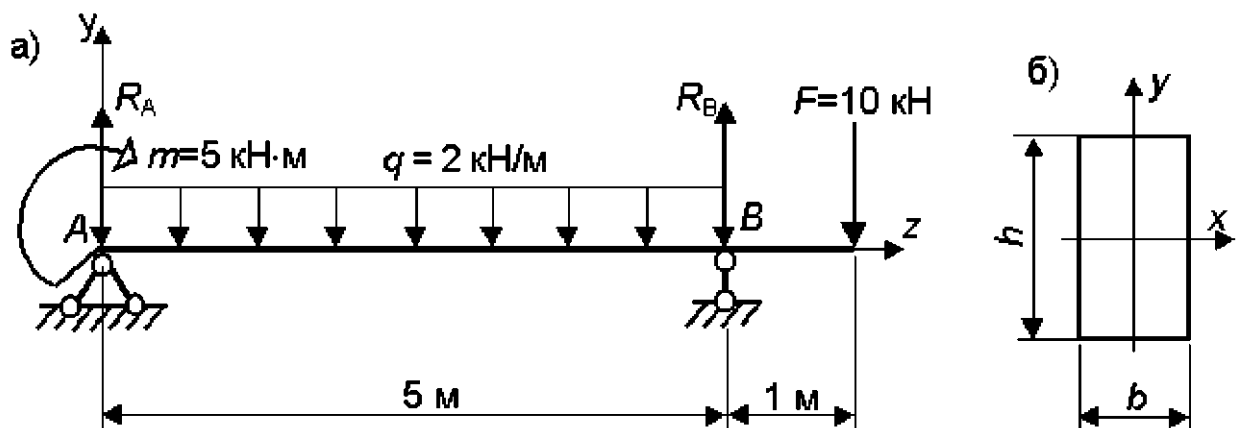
Схема балки: а) расчётная схема; б) схема поперечного сечения
